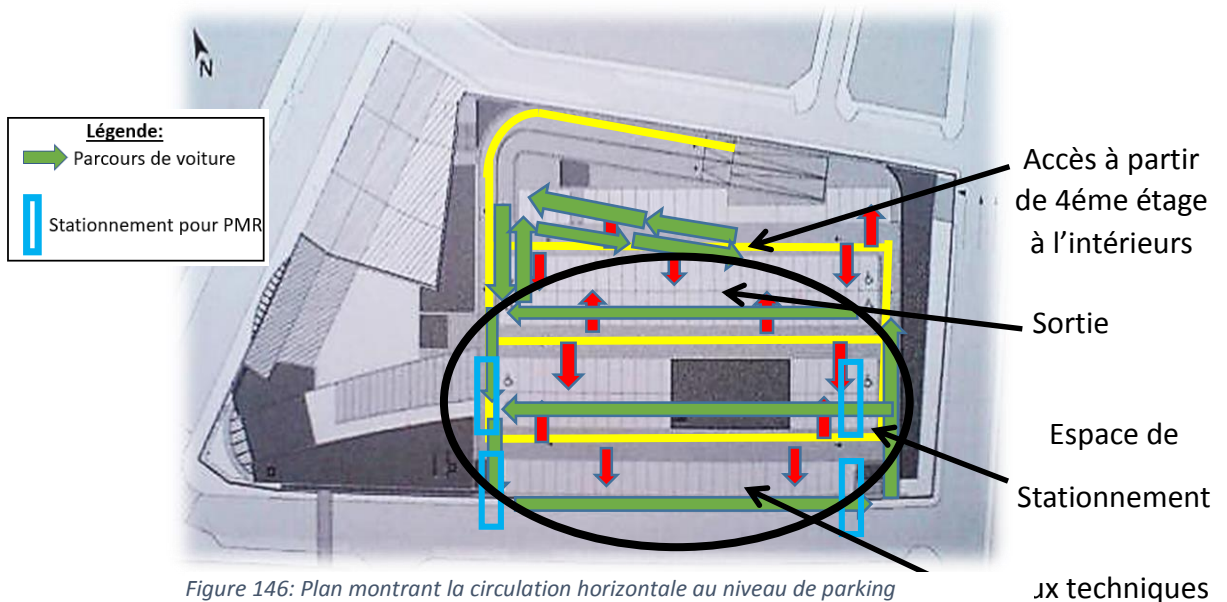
Plan montrant la circulation horizontale au niveau de parking
